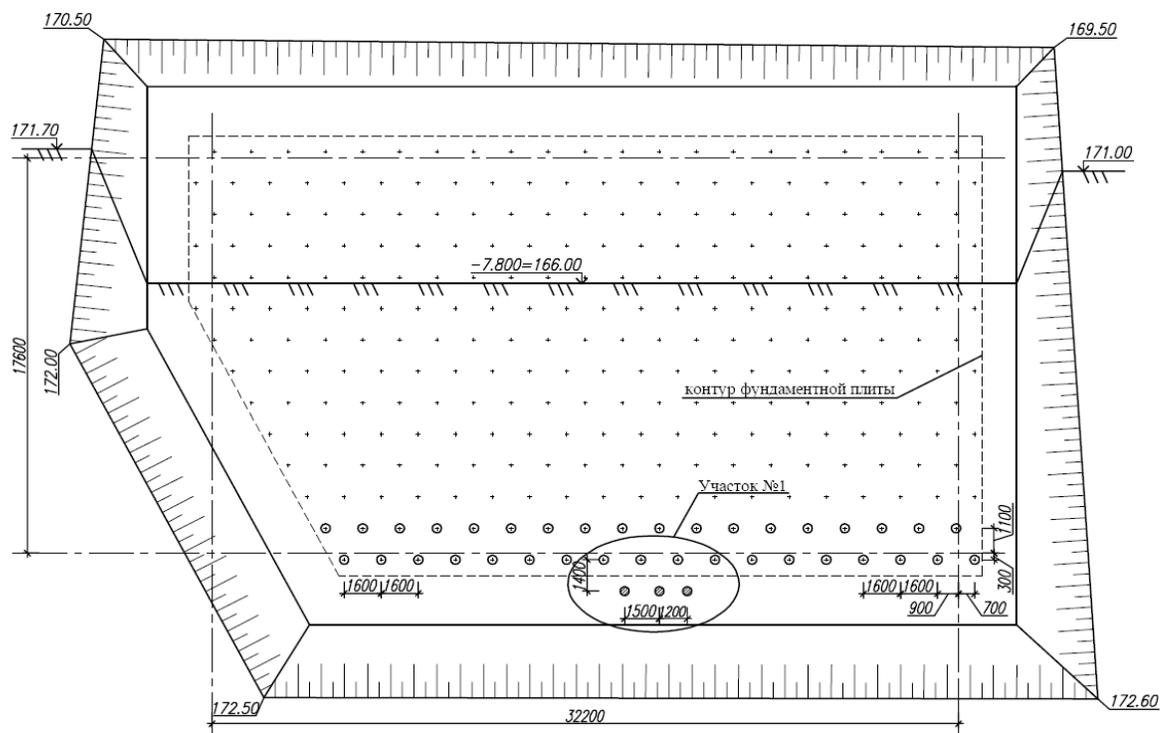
Общая схема котлована с выполненными грунтовыми сваями.
